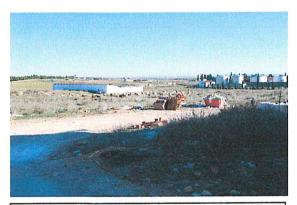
Foto del estado actual del conjunto de eras. Se puede ver como las obras de la zona las utilizan para colocar el material.
